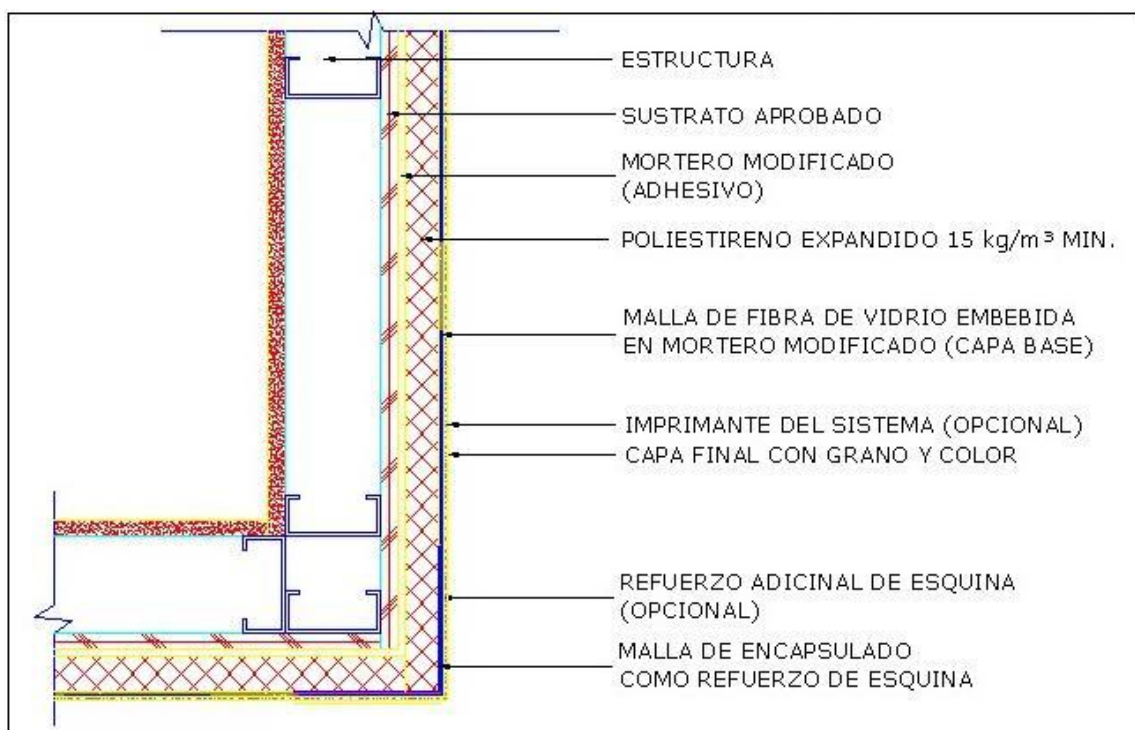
k. Detalle constructivo de refuerzo de esquina en EIFS
